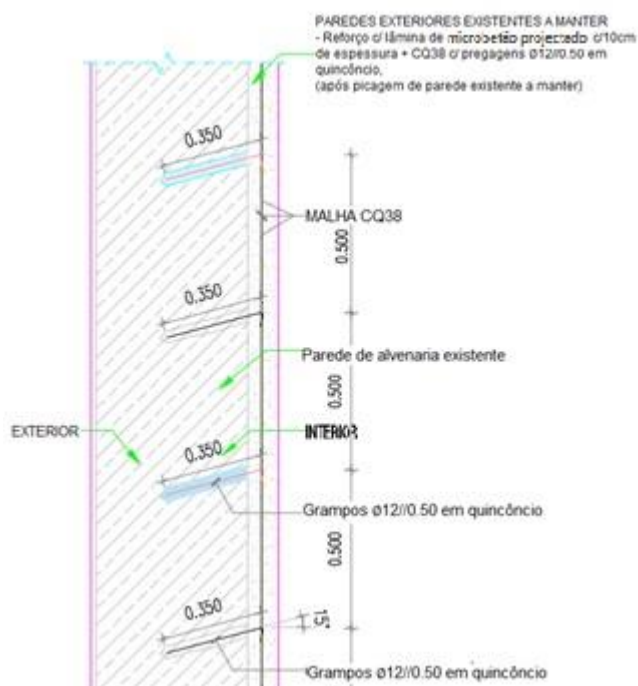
Pormenor da lâmina de microbetão a aplicar
